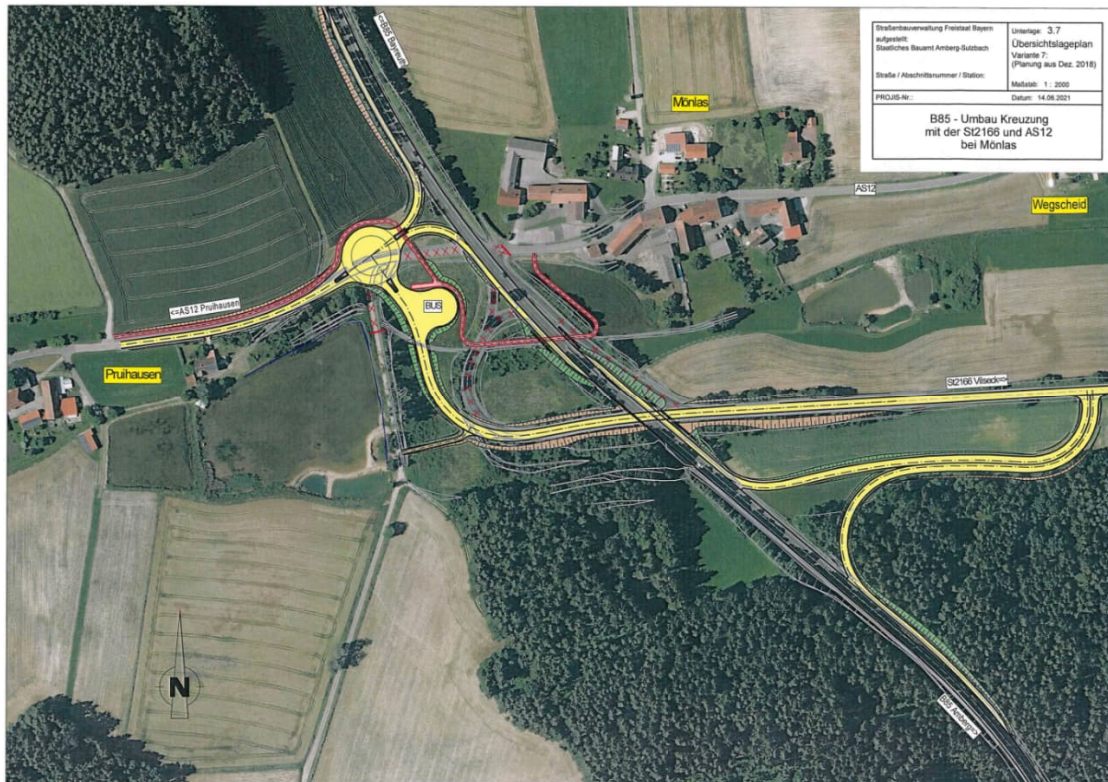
Lageplan "Variante 3" (Eigenplanung: Staatliches Bauamt Amberg-Sulzbach)
